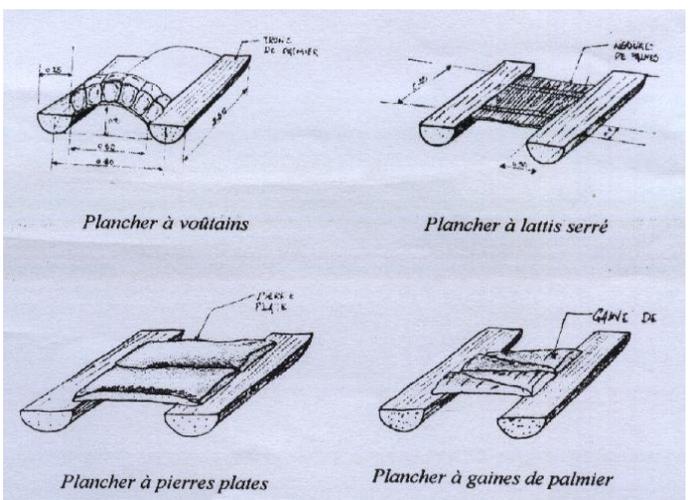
detalles constructivos de palma (Exposé du mzab)
